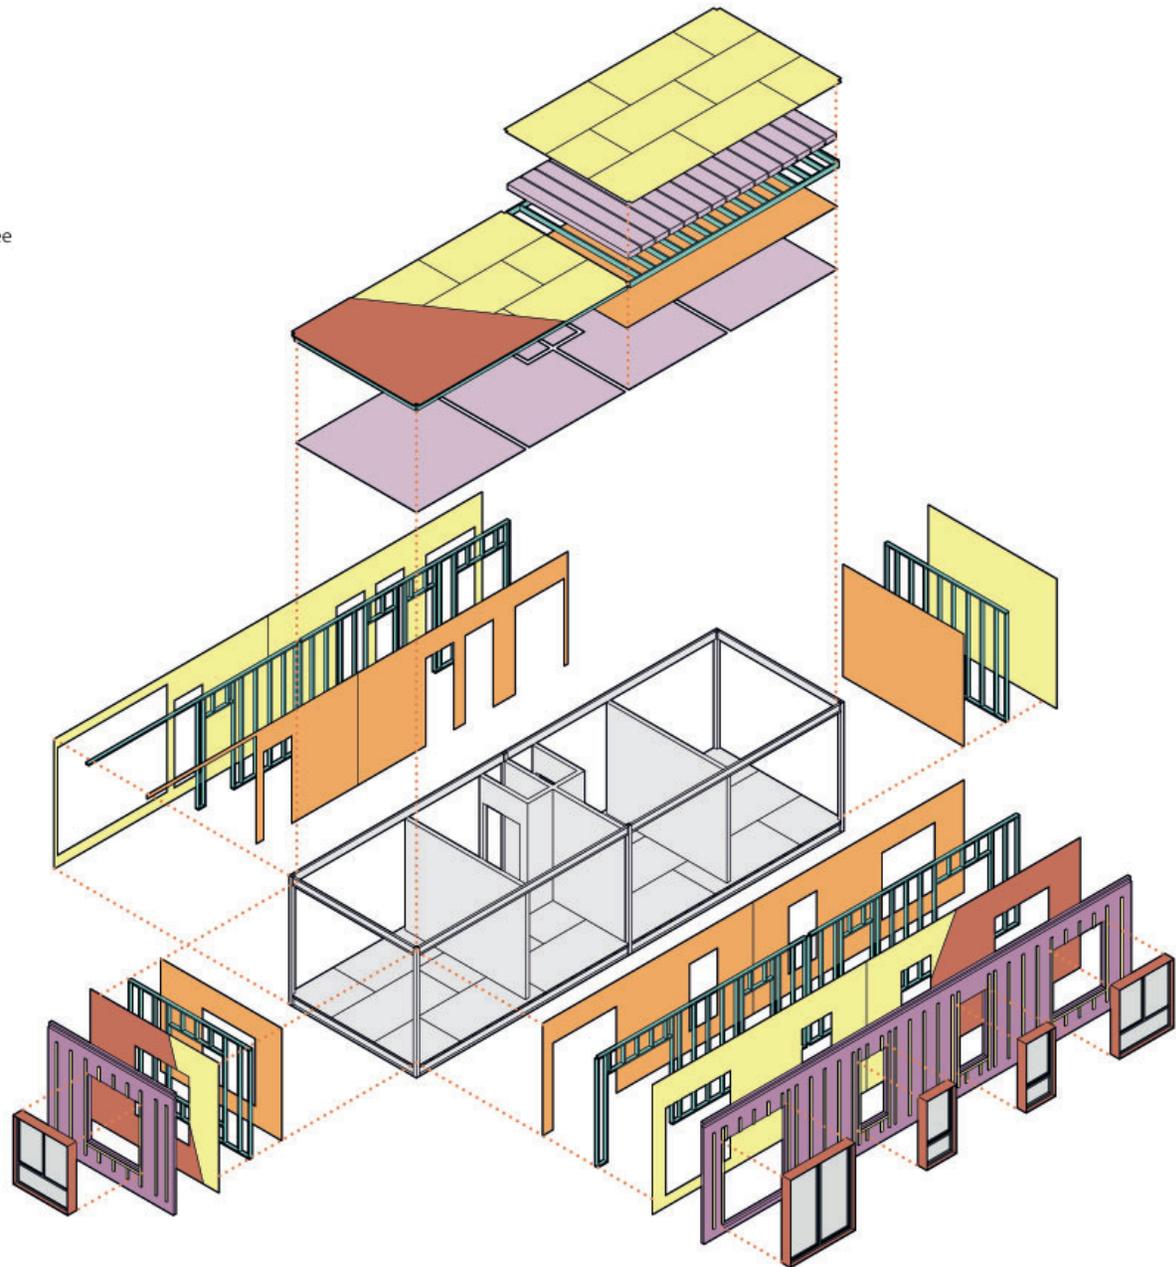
Déconstruction au niveau des composantes (source: BOON architecture)
